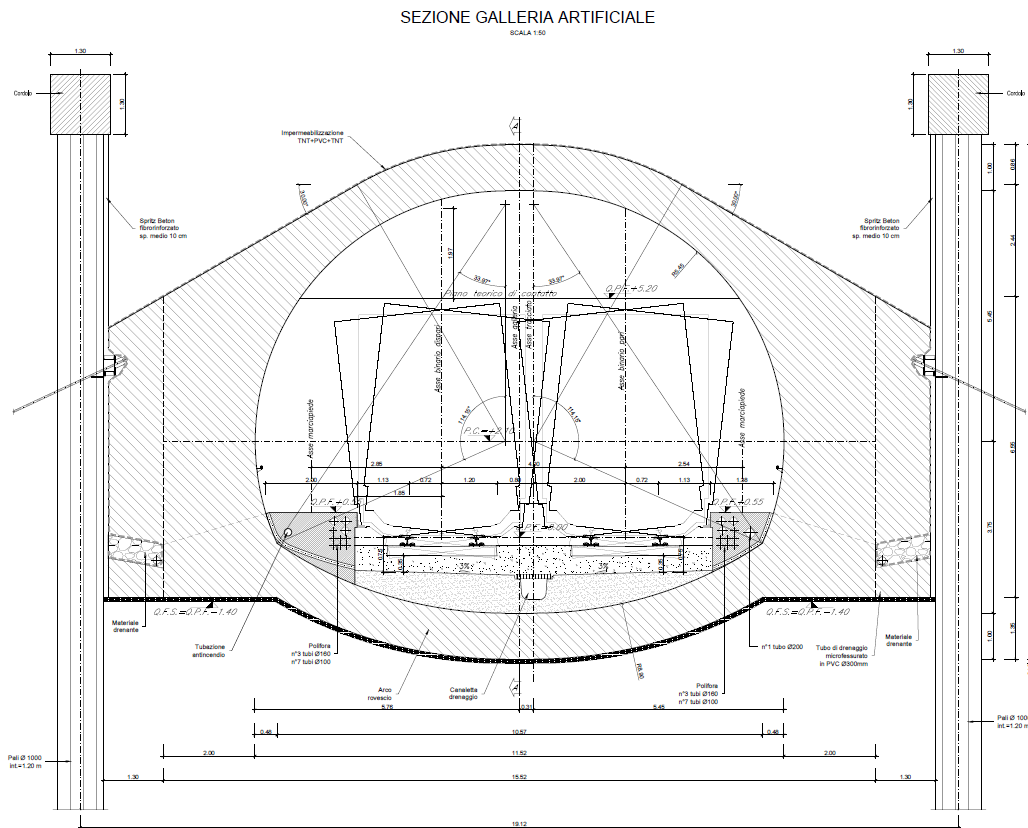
Sezione trasversale – galleria artificiale policentrica.
